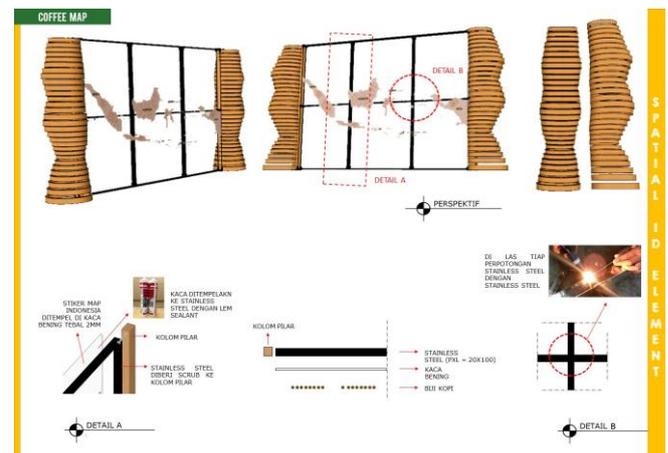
Tampak, potongan dan detail elemen interior *coloumn
